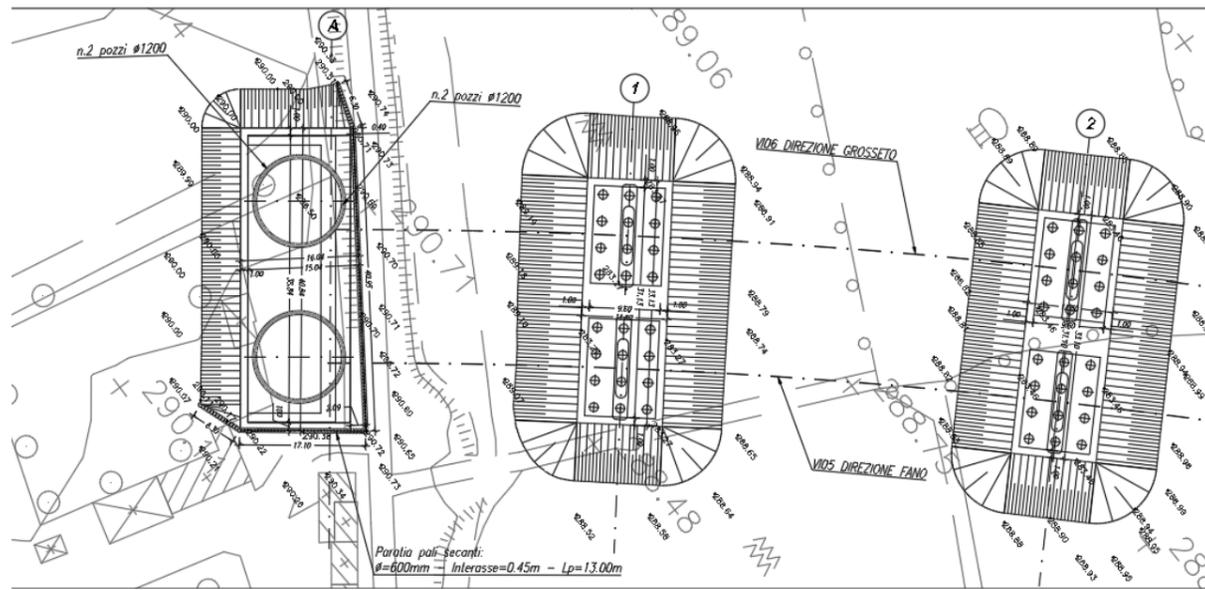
Pianta fondazioni e scavi in prossimità dell'alveo
